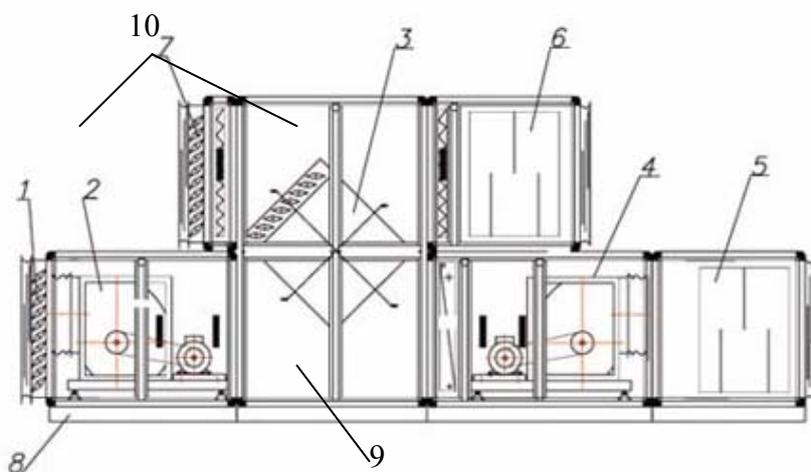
Приточно-вытяжная установка с пластинчатым
